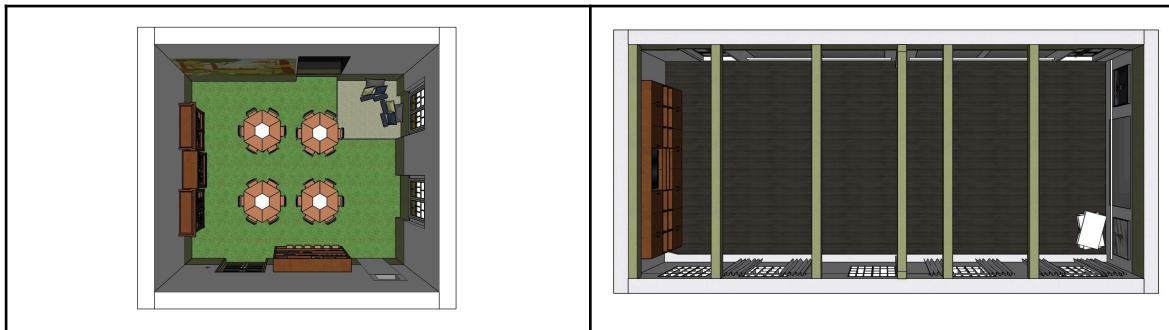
Plantas 3D em SketchUp. Fonte: Autoras
